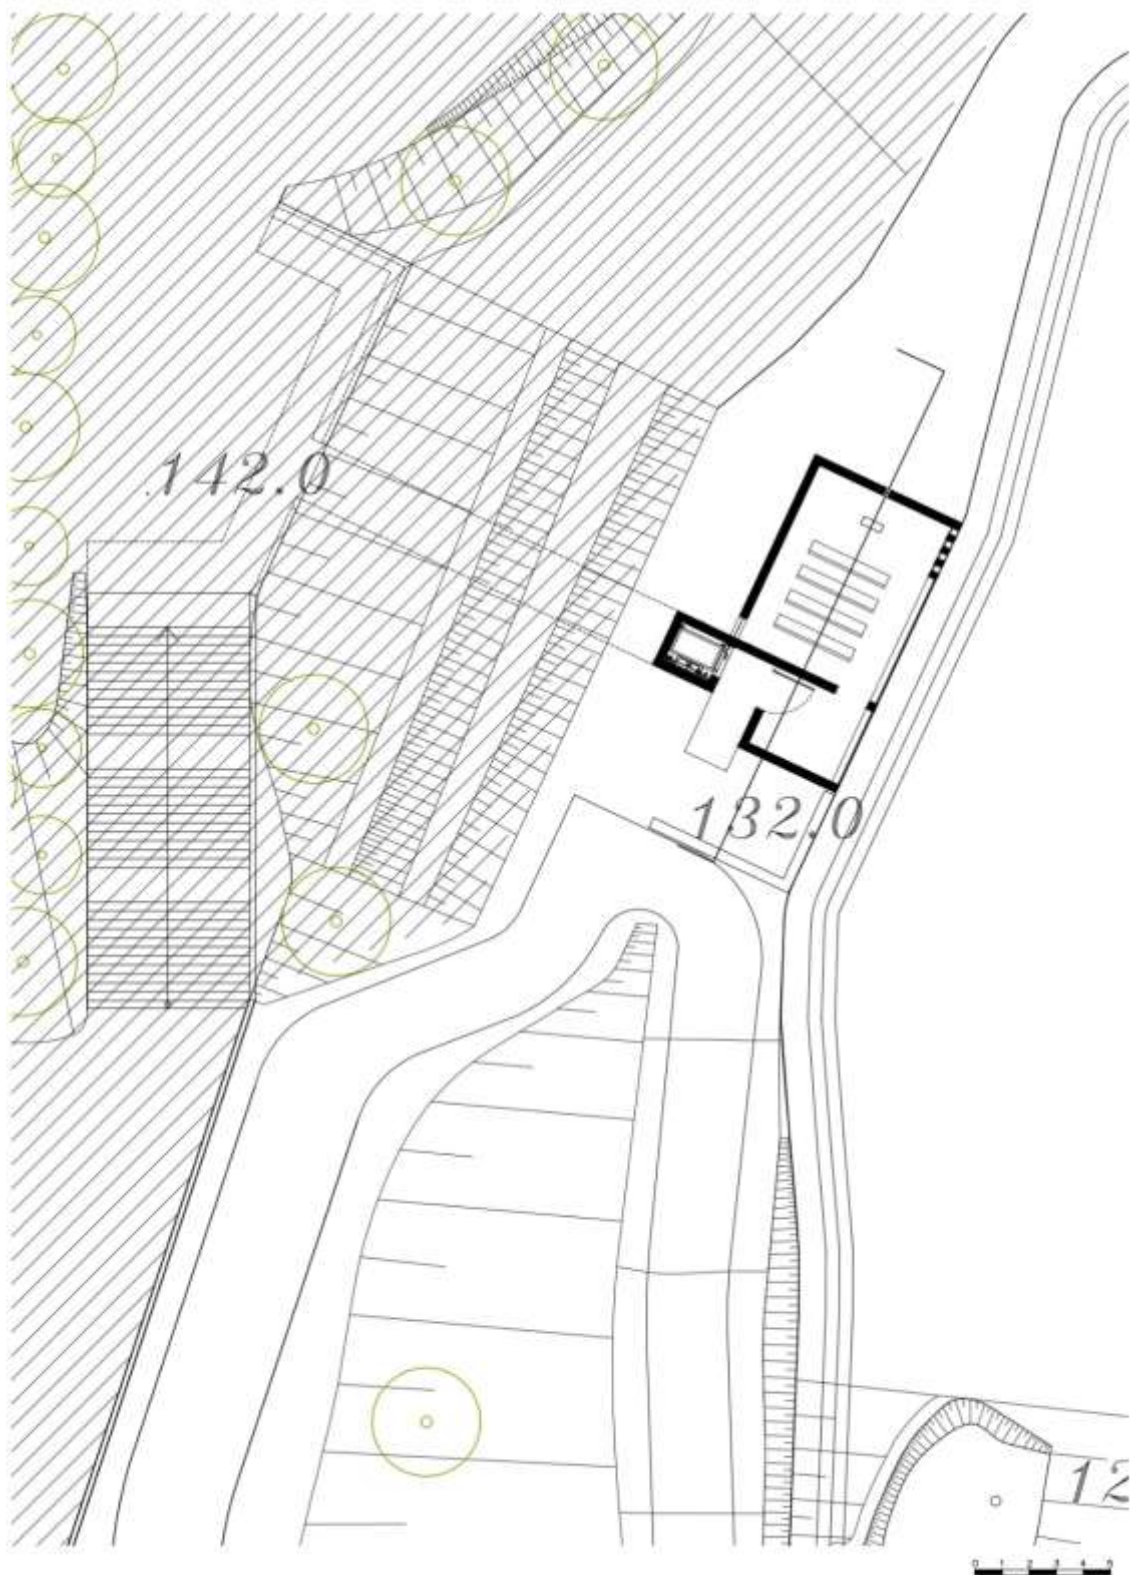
Planta da Capela, escala 1/200. Fonte: Autoria própria
